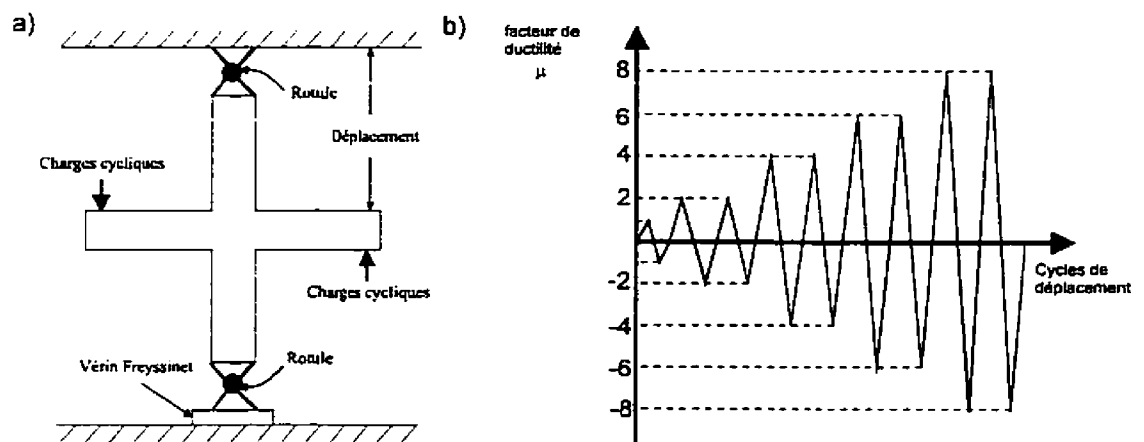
Illustration d'un essai quasi-statique sur un assemblage poteau-poutre (inspiré de Pineau, 1994).
